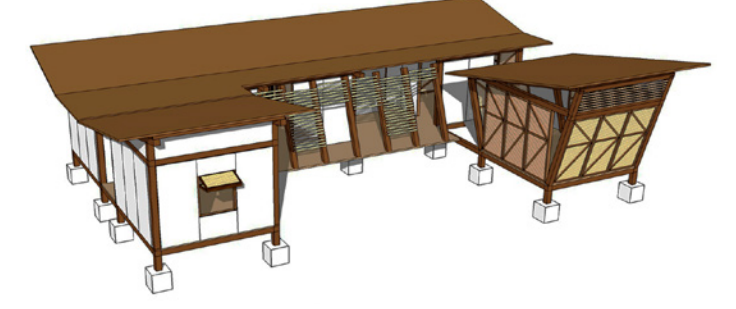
Planimetría tipología de vivienda evolutiva.
